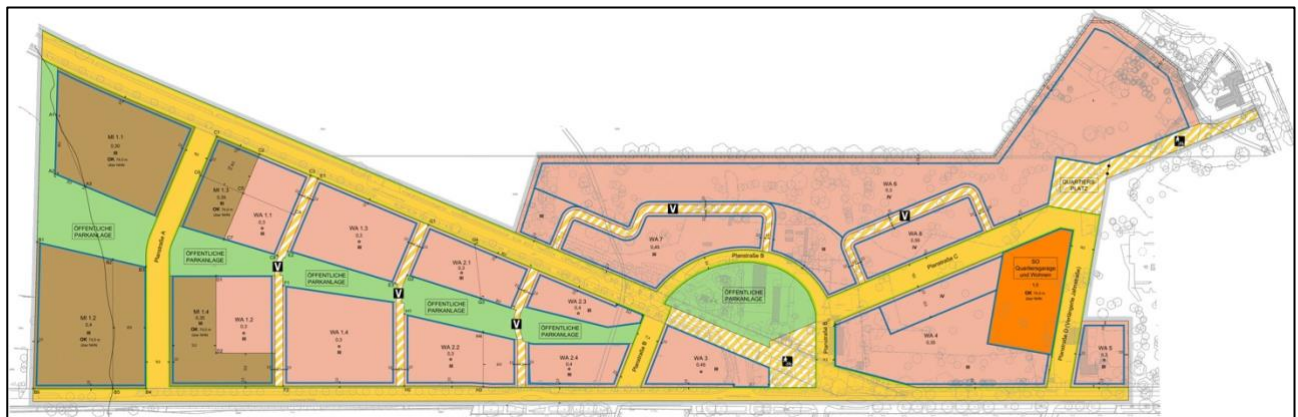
Ausschnitt Bebauungsplan „Ulmenallee“, Entwurf (BSM, Stand Mai 2025)
